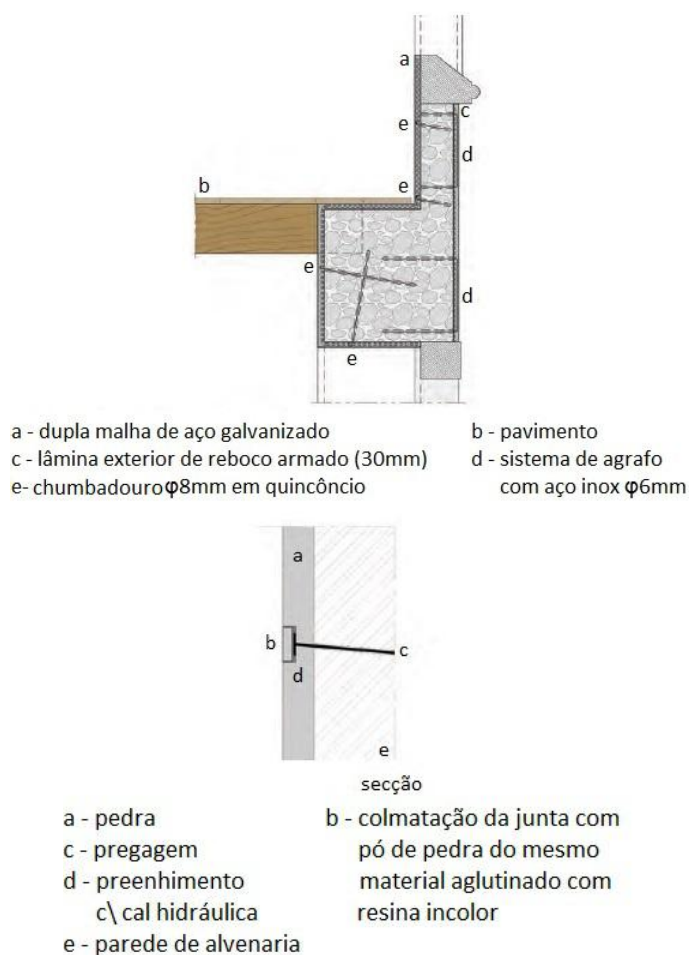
Pormenor das lâminas de reforço das paredes exteriores e da pregagem da pedra de revestimento exterior (adaptado de [41])
